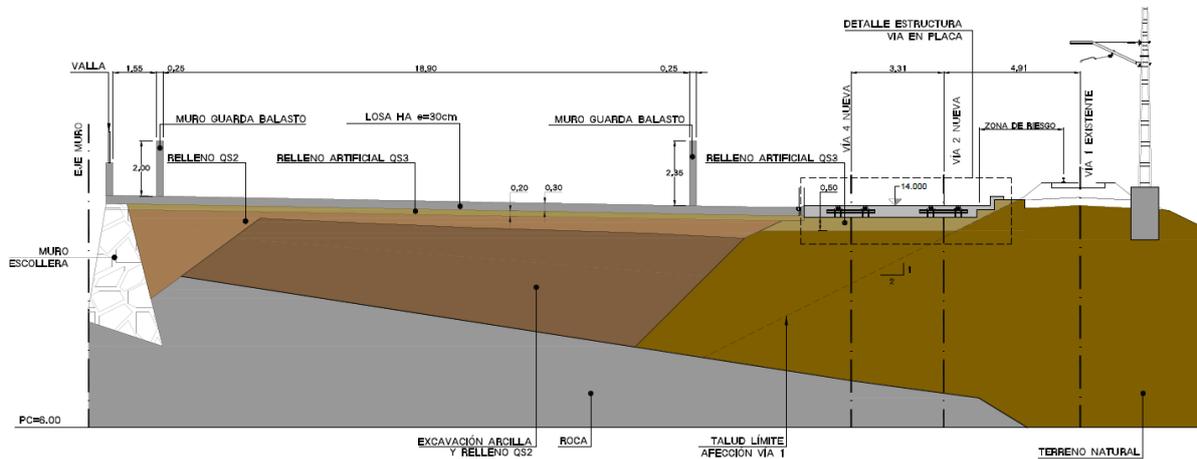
Sección tipo de estructura proyectada. Pueden verse las mejoras de terreno planteadas.
